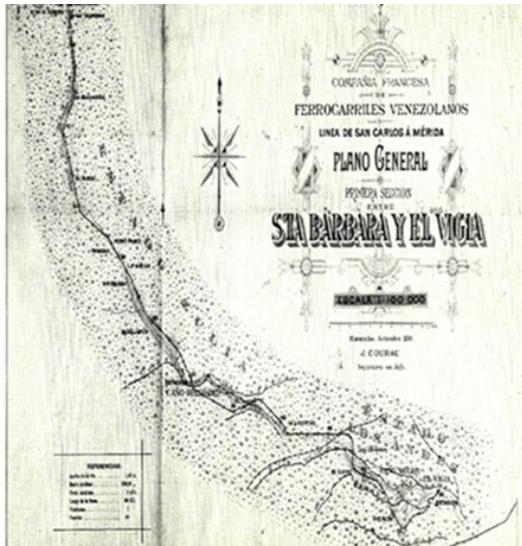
Plano Ferrocarril Santa Bárbara-El Vigía.
